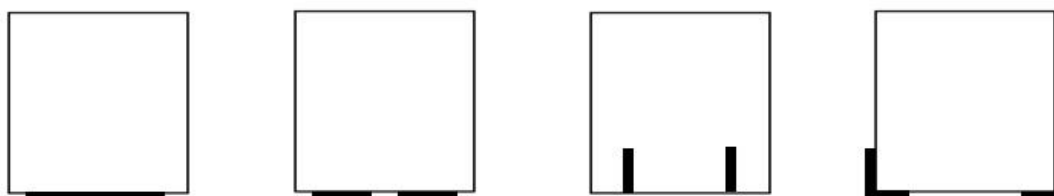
Основные схемы внешнего армирования растянутой зоны изгибаемых деревянных конструкций
